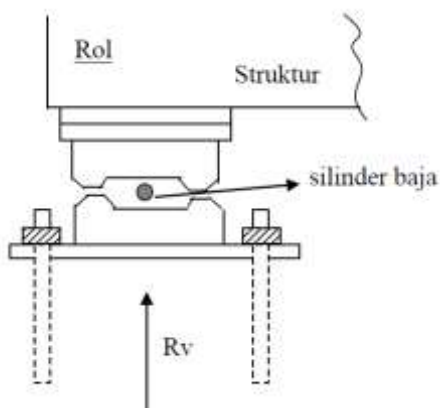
Ilustrasi perletakan bangunan Gedung dan pondasi
